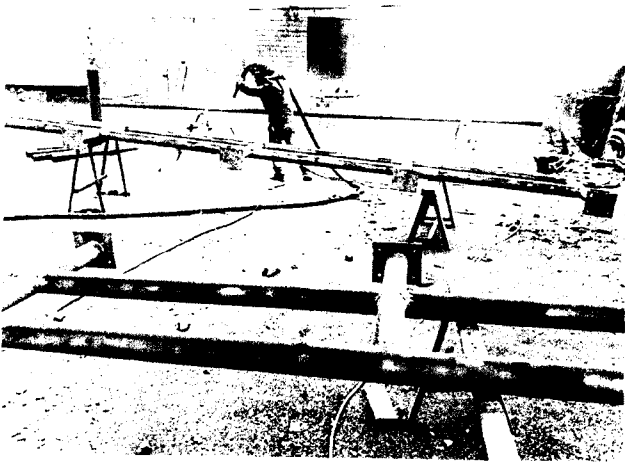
Fabricación y pintado de barandas para instalación en el muelle San José
